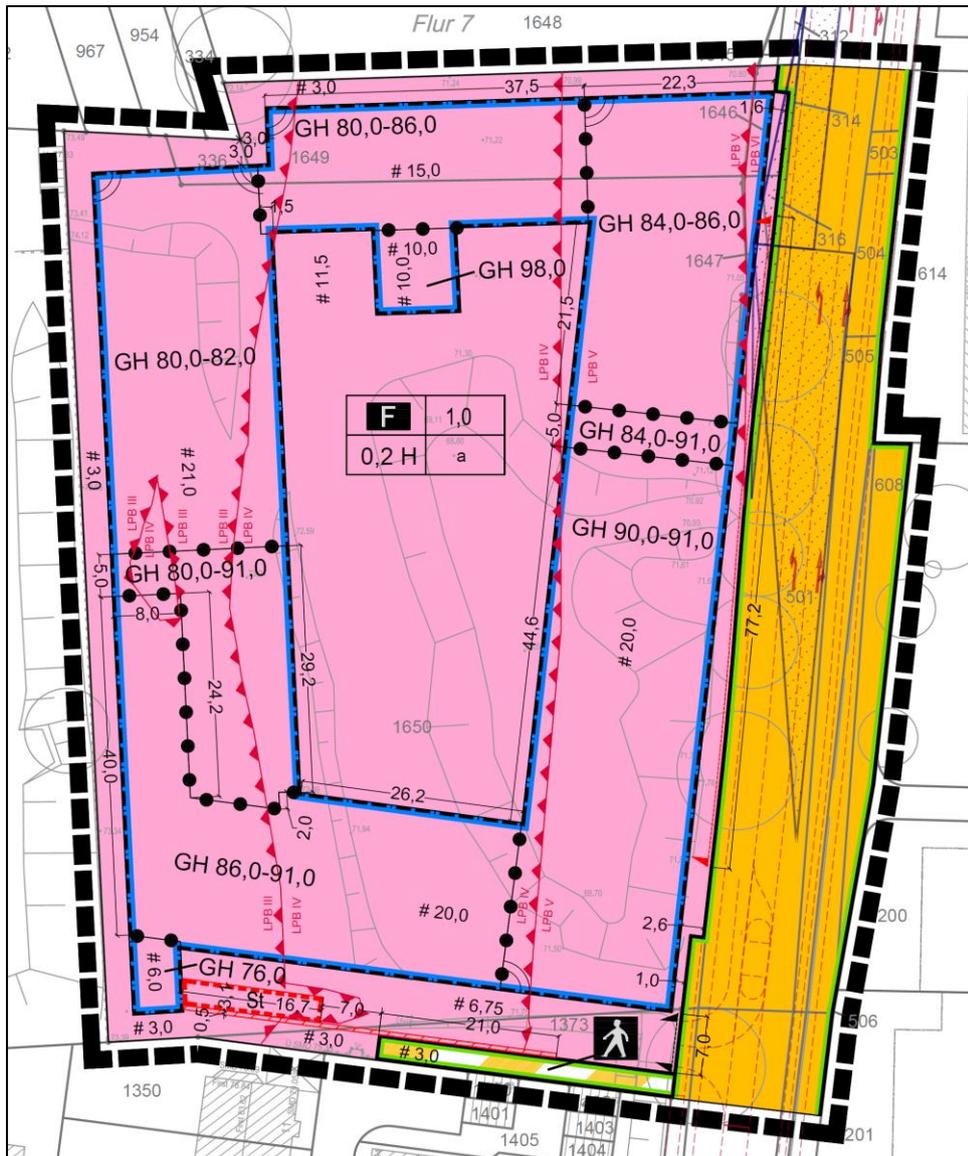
Bebauungsplan (Stand: Mai 2023, H+B Stadtplanung)
